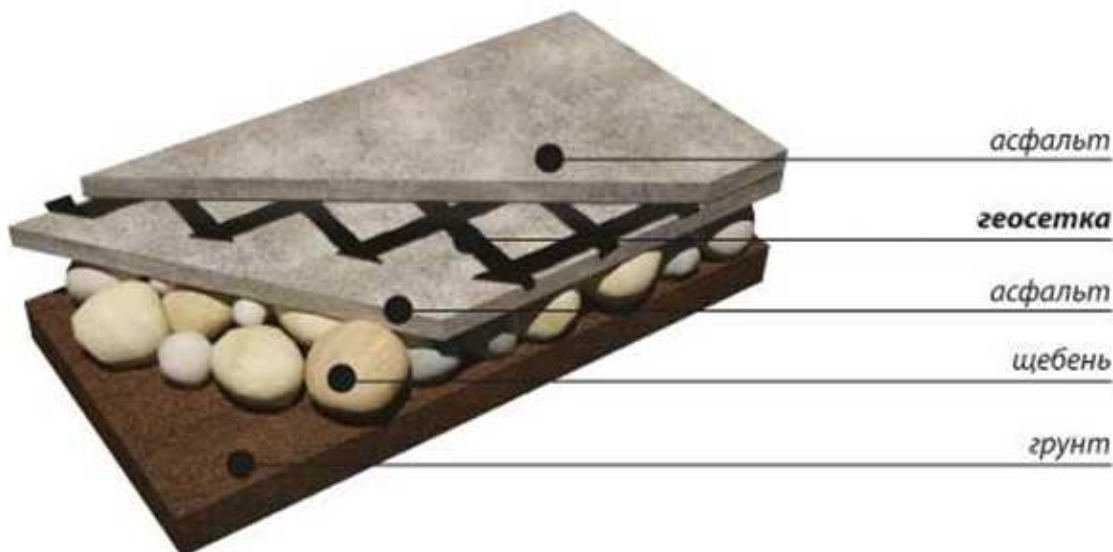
Схема расположения полотен геосеток при сплошном армировании
